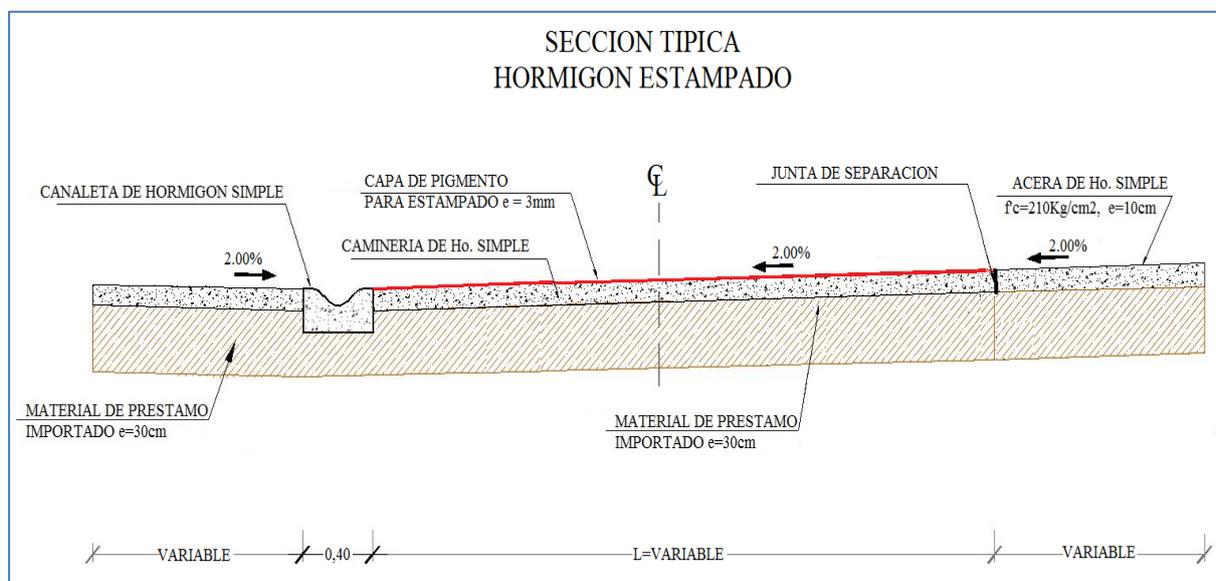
Sección típica propuesta para pavimento de hormigón pigmentado-estampado
